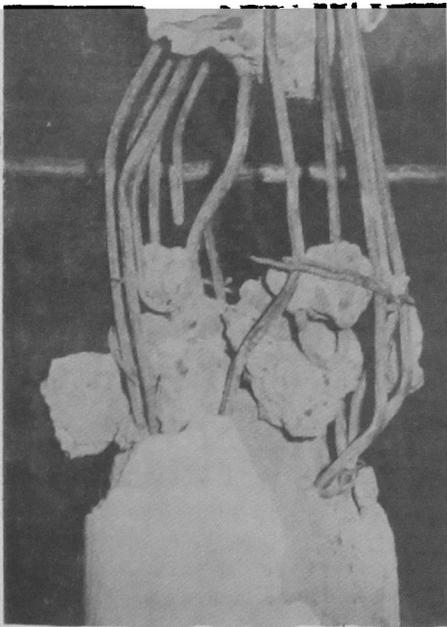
Pandeo de barras en pilar. Edificio de Saavedra Benard. Osorno.
